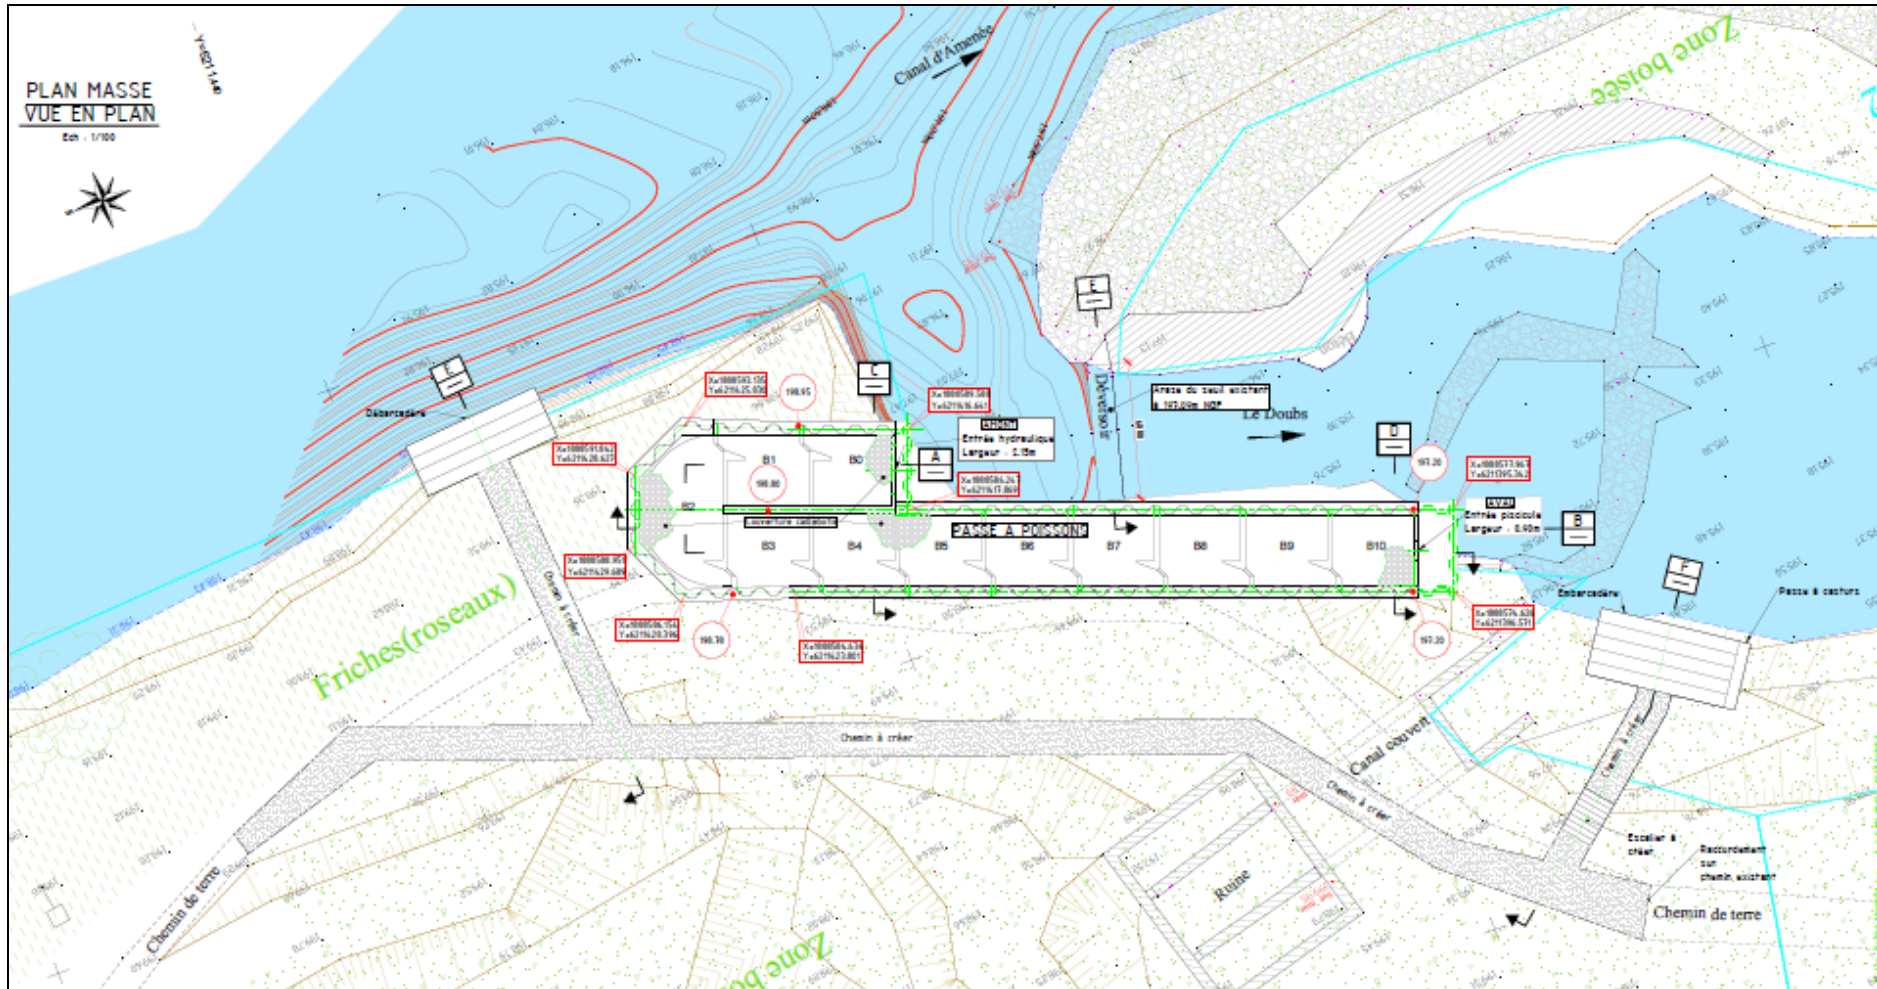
| Plan de masse de la passe à poissons de Crissey. Source : HYDROSTADIUM
